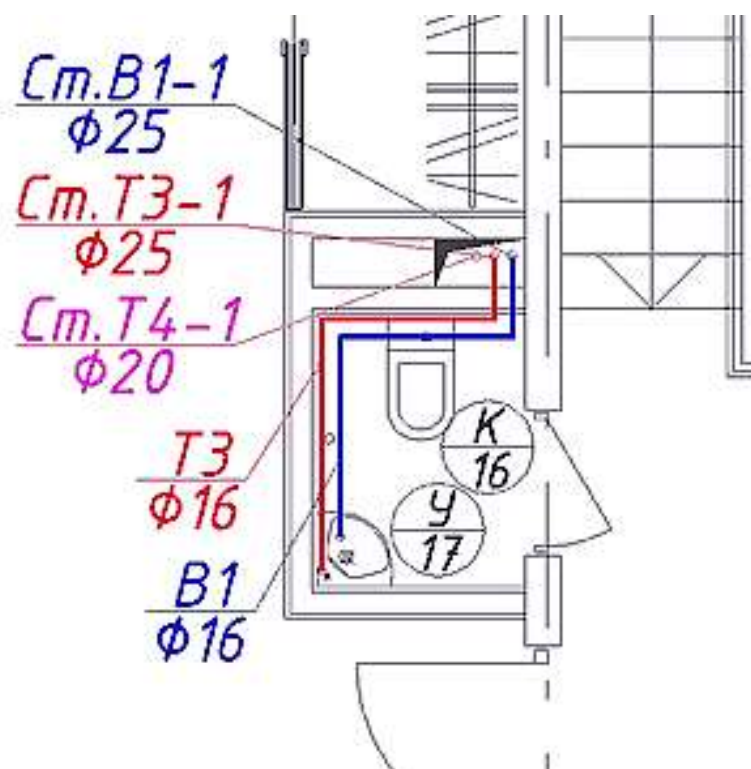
Пример фрагмента плана этажа со схемой системы водоснабжения
